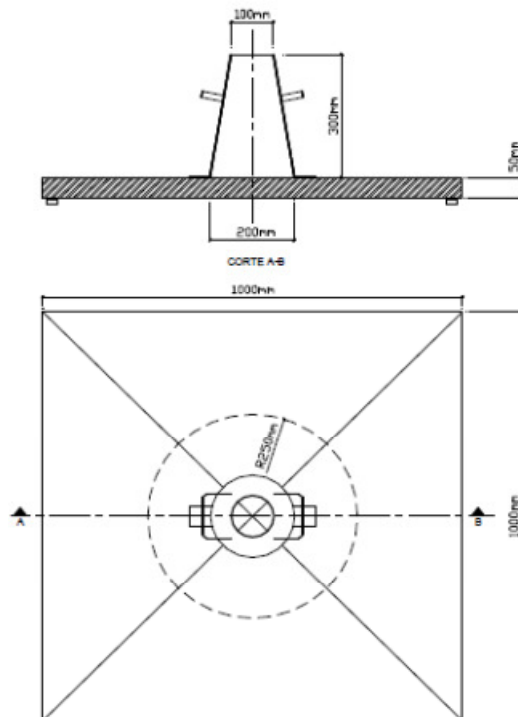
Ensaio de espalhamento para o betão, utilizando o cone Abrams [5]
